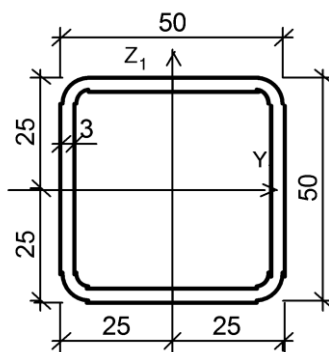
Поперечное сечение рядового раскоса фермы
